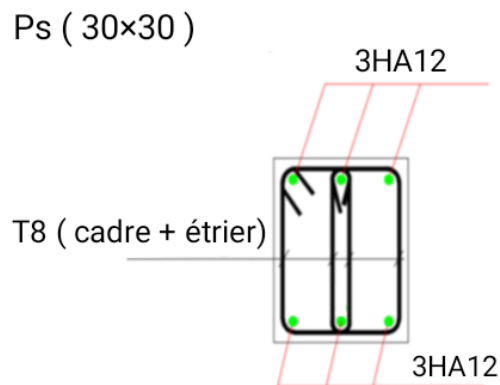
Schéma de ferrailage de la poutre secondaire
